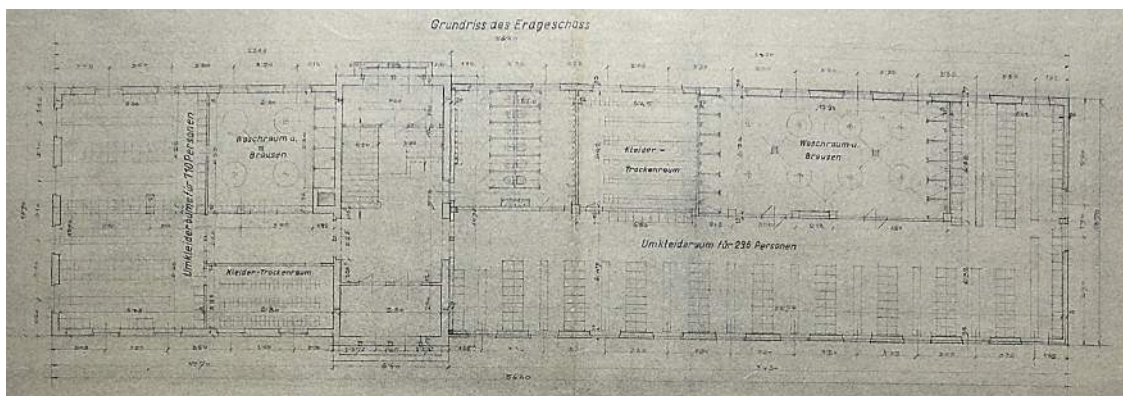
Planausschnitt Erdgeschoß der Umbauplanung von 1941
